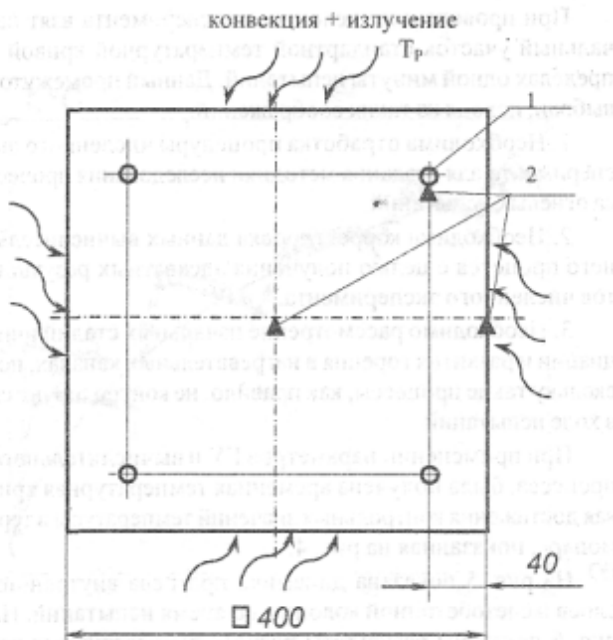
Конструктивная схема сечения испытуемой железобетонной колонны: 1 — арматура; 2 — места расположения термодпар
